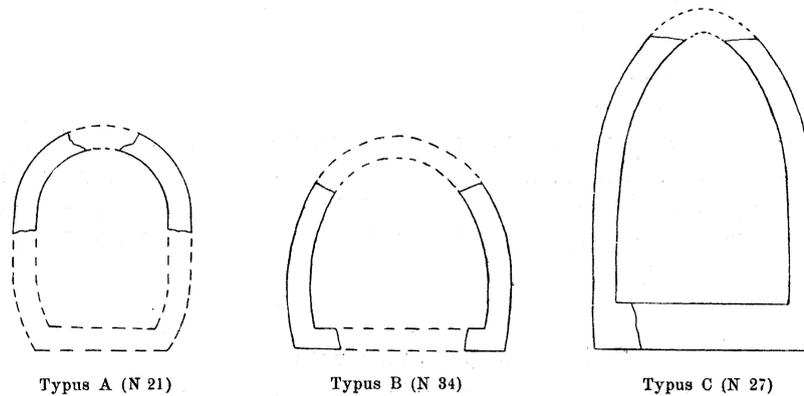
Grundrisse der Ovalbauten, ergänzt.
